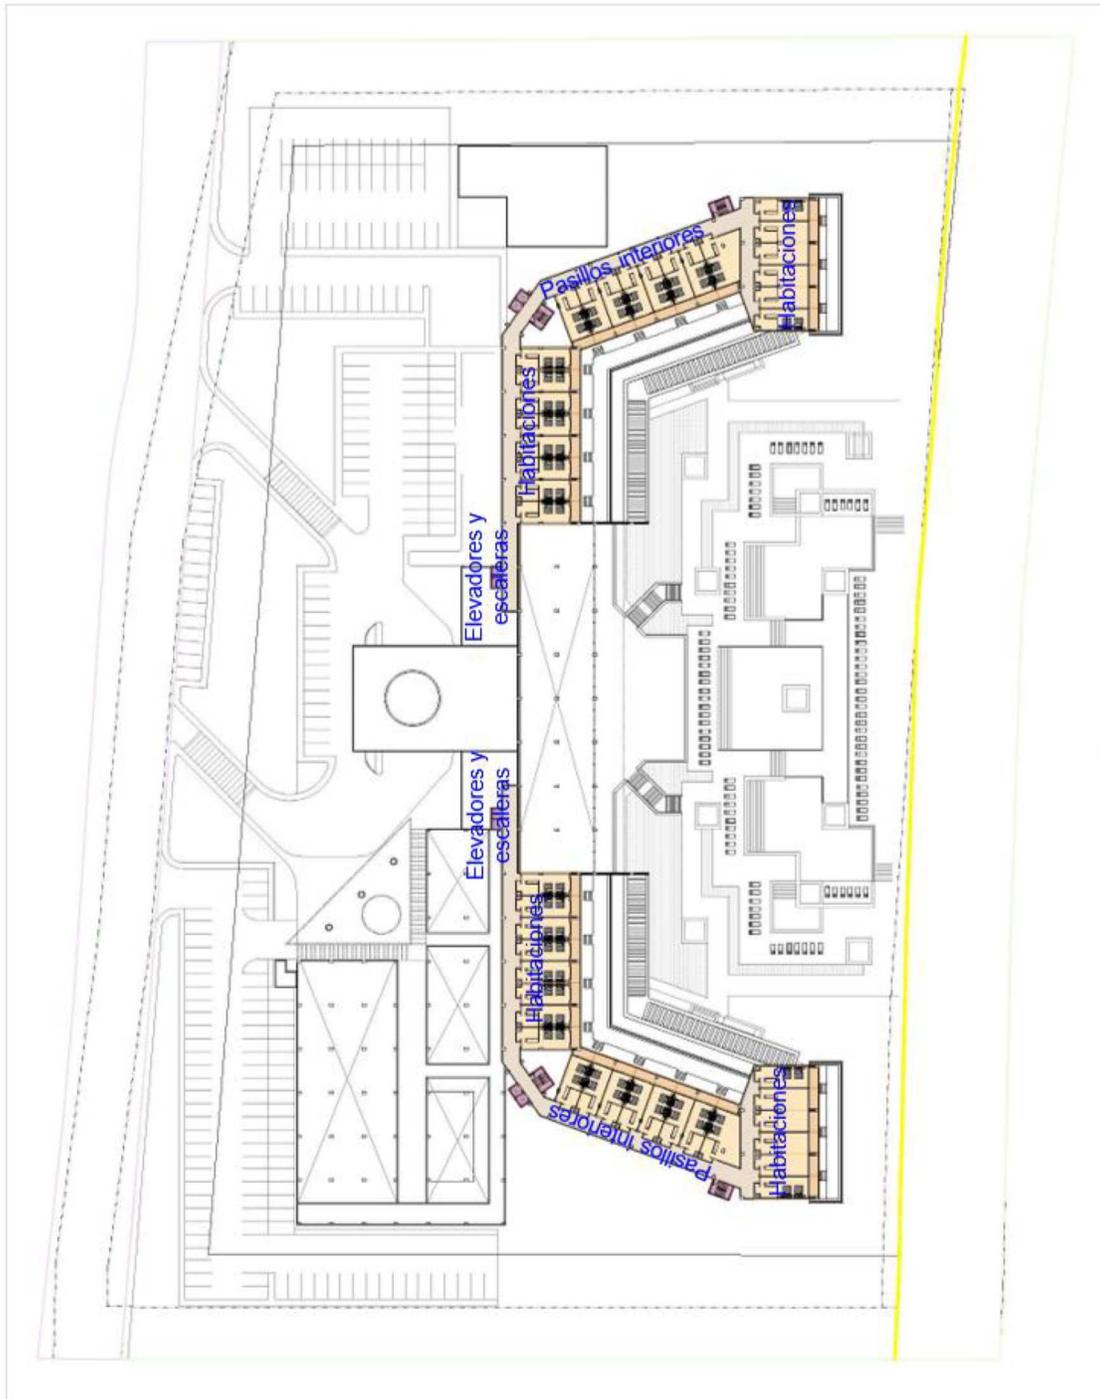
Obras del proyecto en niveles 2 y 3 nivel, donde se ubican habitaciones, pasillos interiores y elevadores y escaleras
